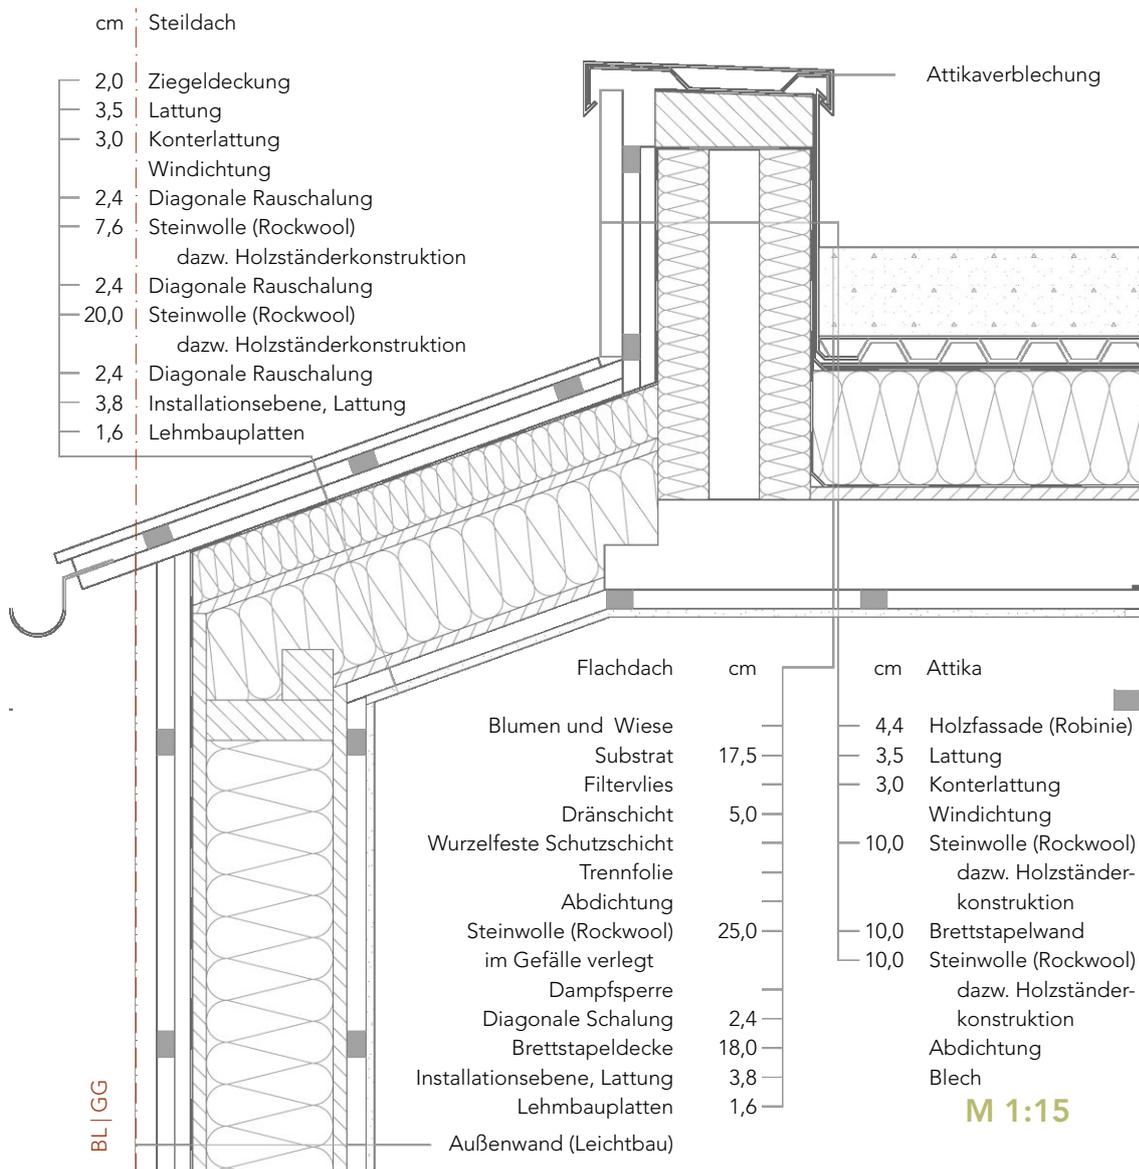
Anschluss Steildach an das Flachdach samt Attika
